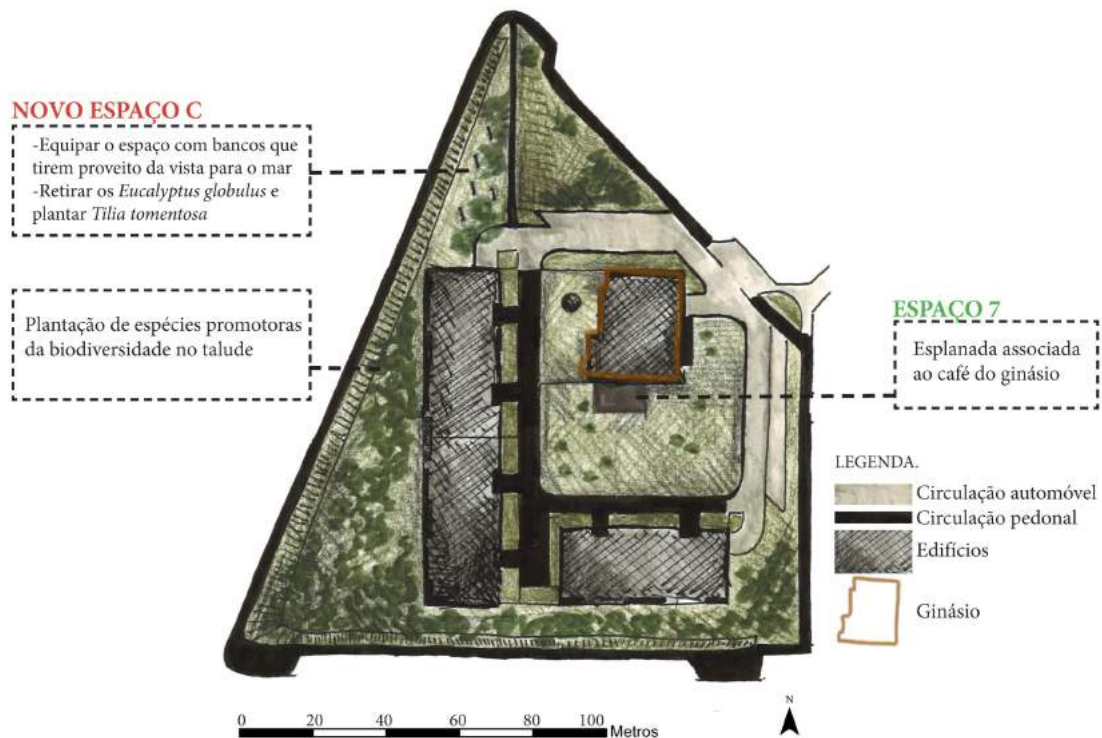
Plano geral área 3 (Beatriz Castiglione)
